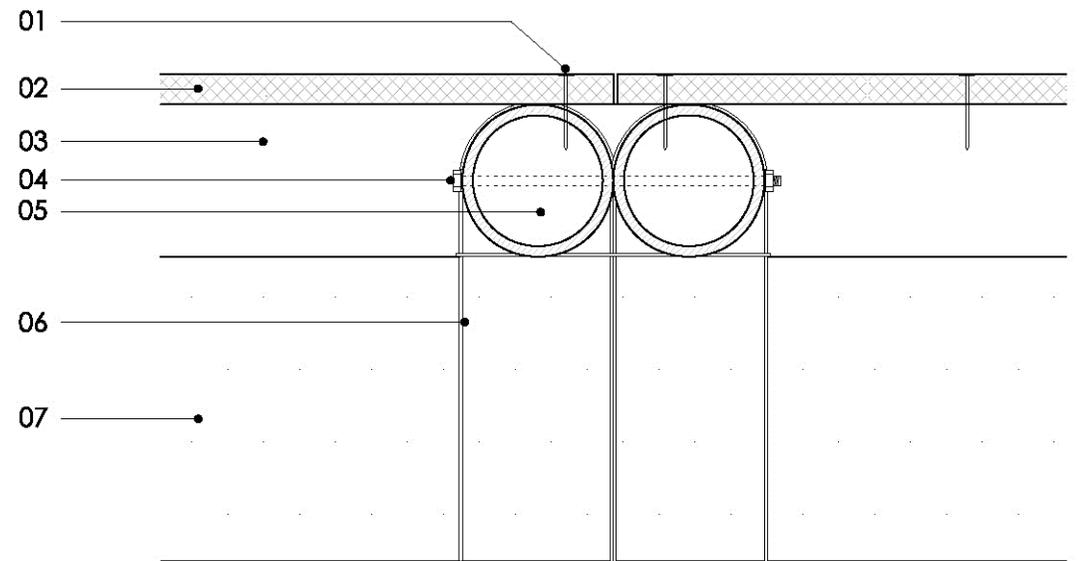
Solución constructiva para estructura del piso de la vivienda flotante.
